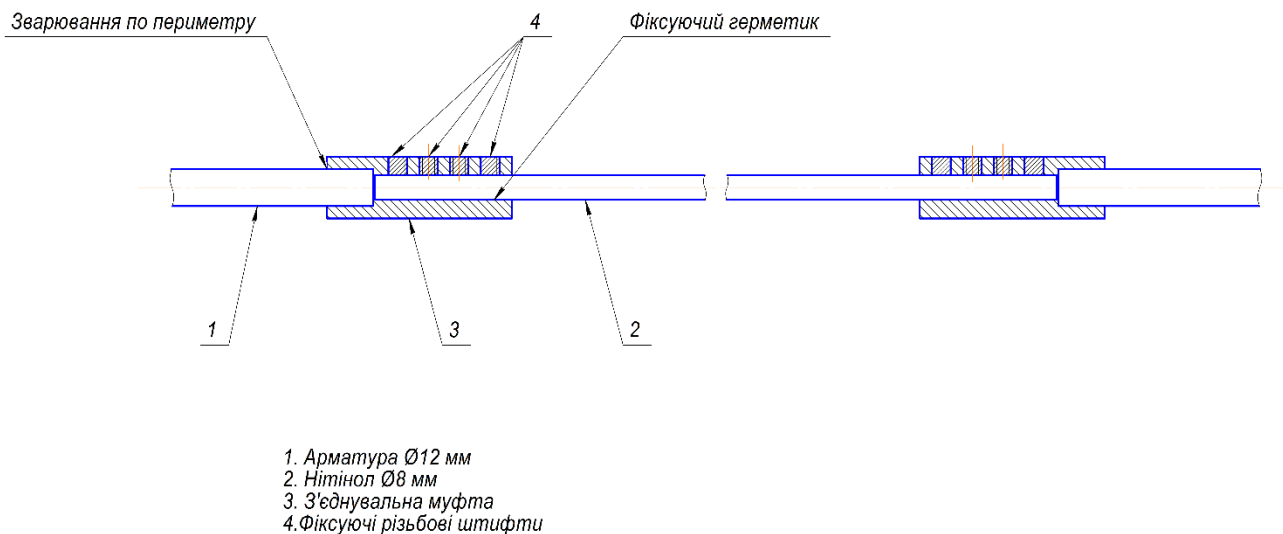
Схематичне зображення з'єднання арматури з нітинолом
